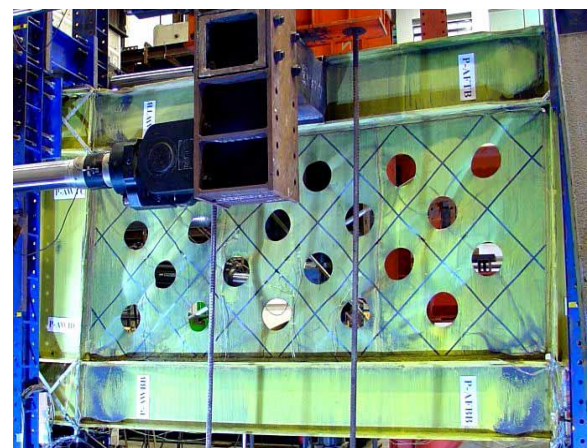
Muro de corte con placas de acero y perforaciones de esquina (Vian y Bruneau, 2004)
